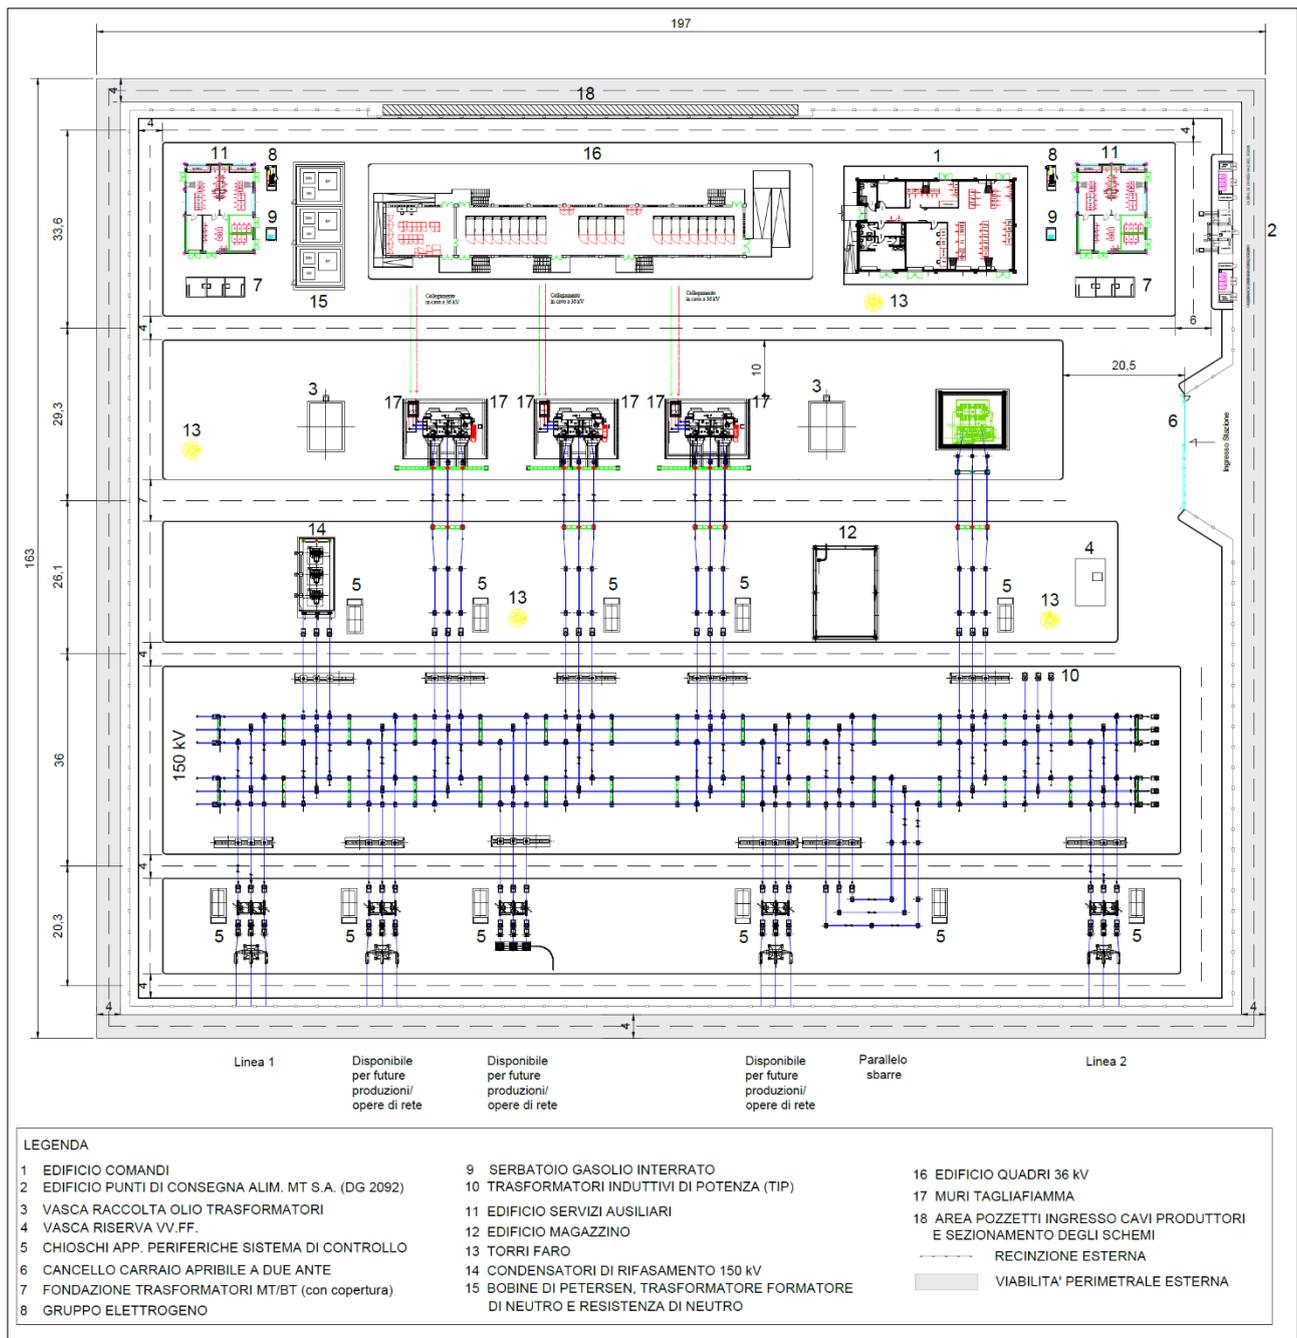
Planimetria elettromeccanica della SE RTN Terna 150/36 kV
